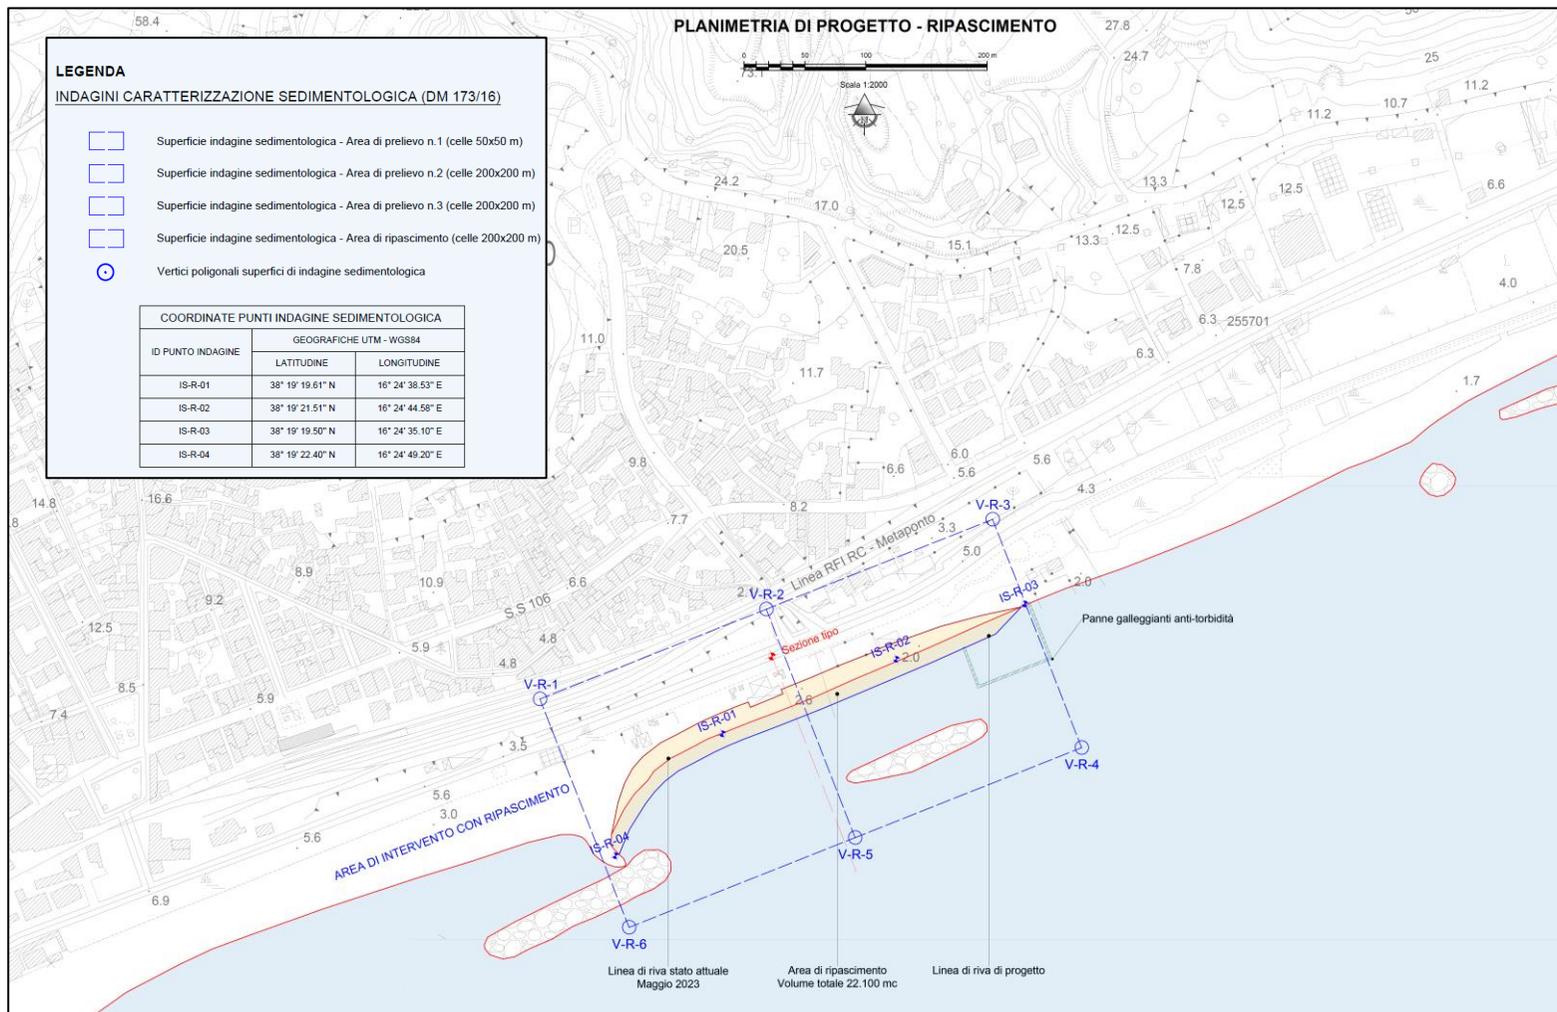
Planimetria di progetto con individuazione punti di campionamento dell'area di ripascimento
